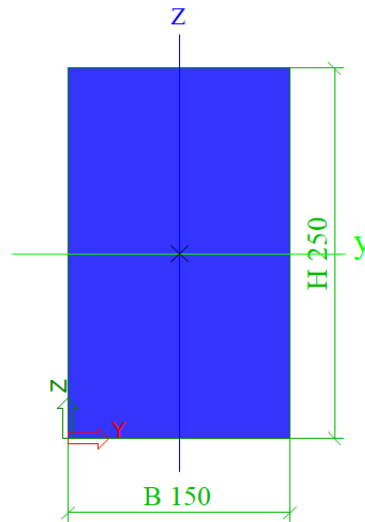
Seção Transversal dos Pilares no Modelo I (dimensões em mm)
